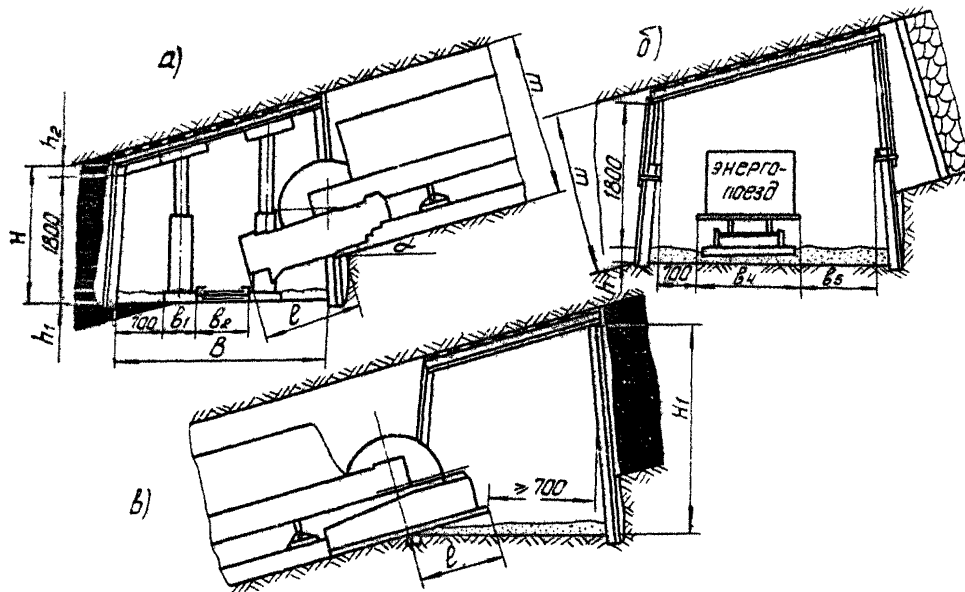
Расчетные схемы определения площади сечения выемочных выработок при безнишевой выемке угля в КМЗ:
